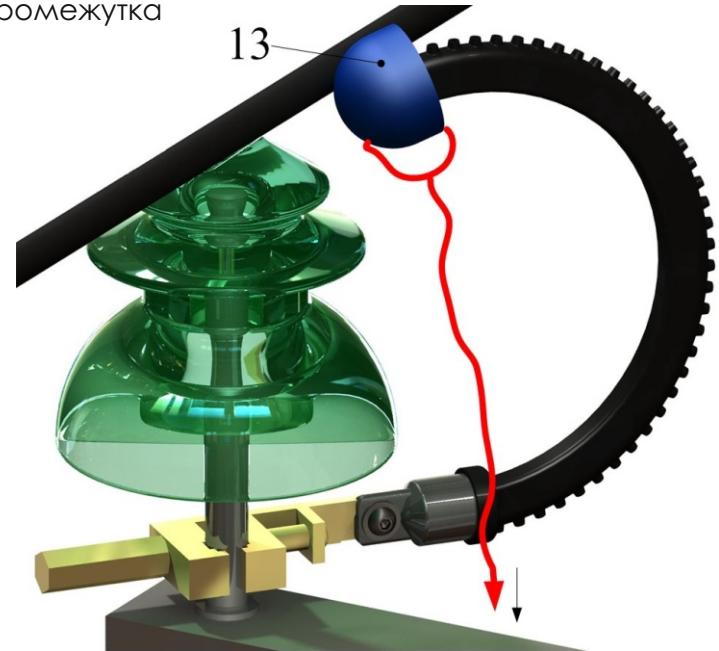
Схема установки разрядника и калибровки воздушного промежутка
